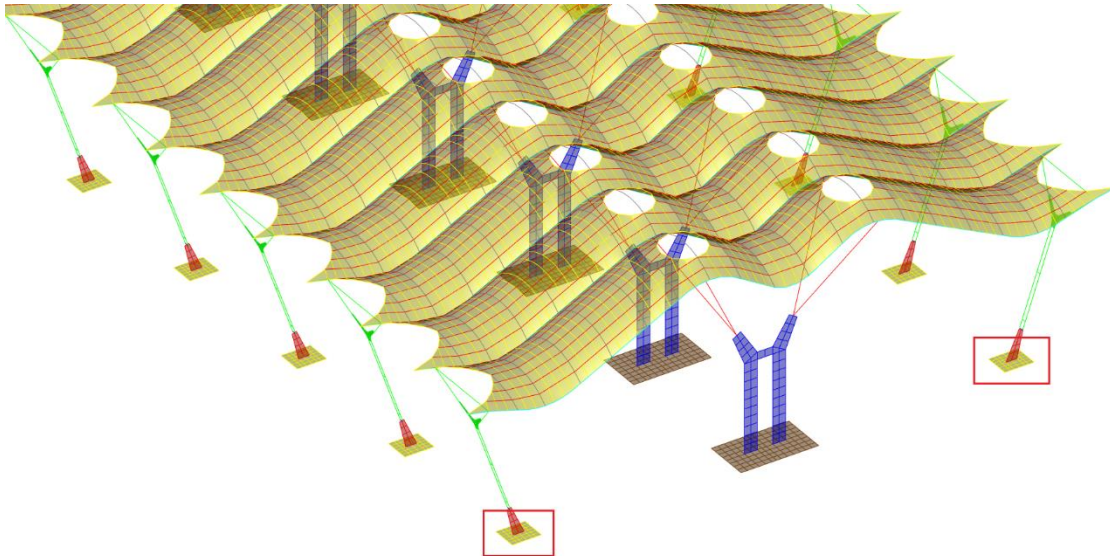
| Captura de SAP2000: Zapatas de los pilares exteriores de hormigón armado. (elaboración propia)
